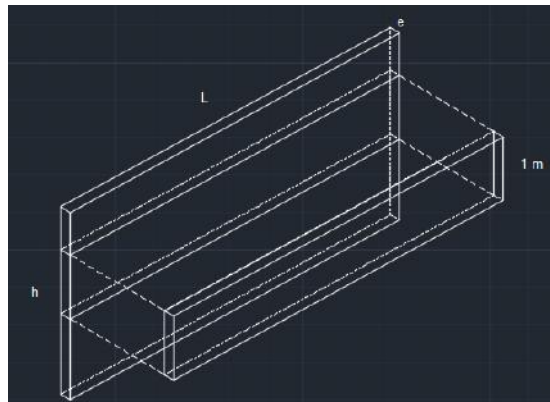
9. Esquema de vigas horizontales empleadas para el cálculo del armado horizontal de los muros.
